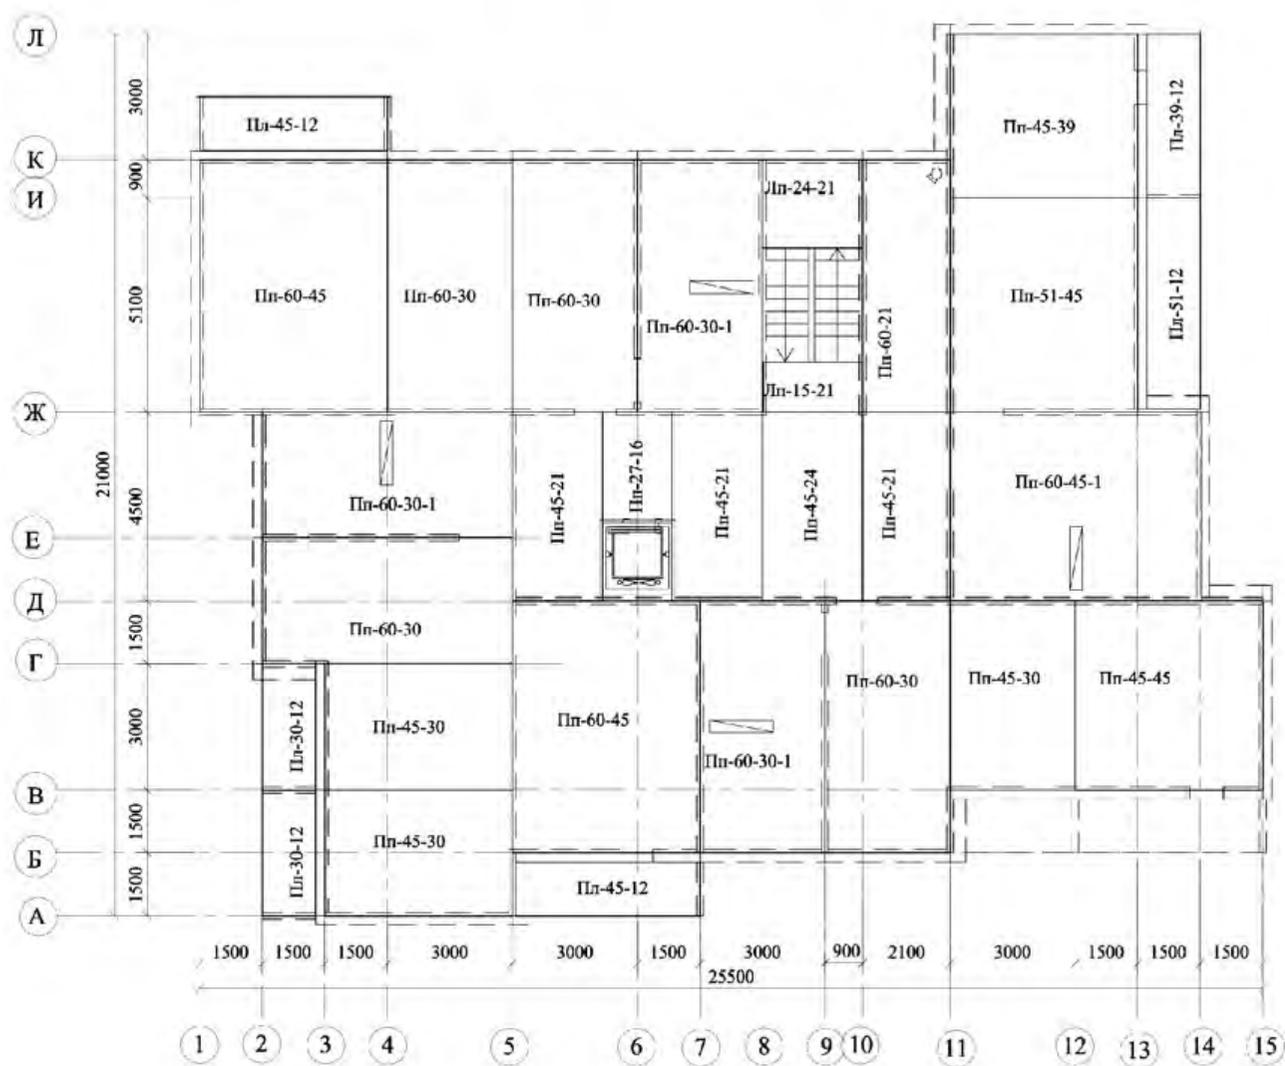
Перекрестная схема расположения плит перекрытия в здании с опиранием плит перекрытия по контуру (плита на комнату) на продольные и поперечные стены
